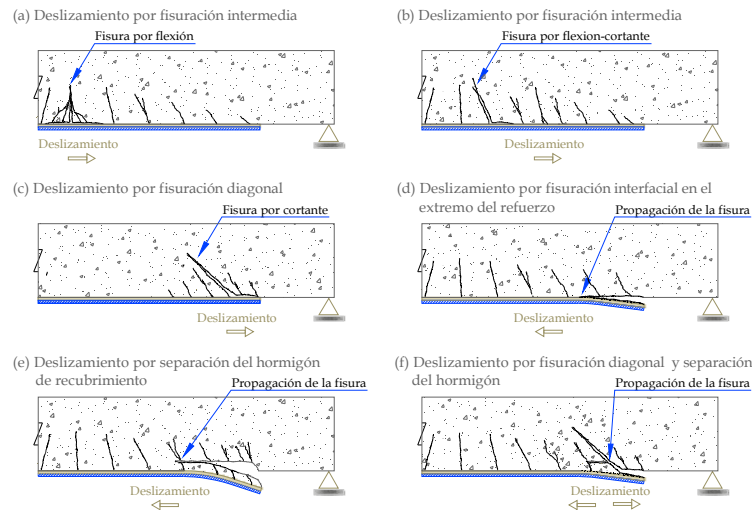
MODOS DE FALLO CON DESLIZAMIENTO EN VIGAS DE HORMIGÓN REFORZADAS CON FRP.
